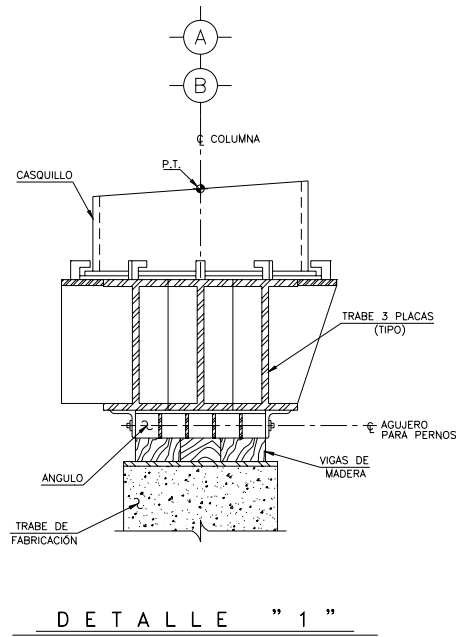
DETALLE 1 DEL PLANO CONSTRUCTIVO DEL MARCO DE SOPORTE Y ARRASTRE DE LA SUPERESTRUCTURA
